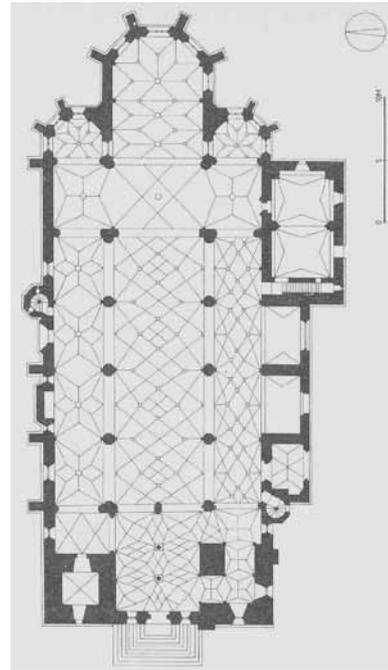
Grundriss der Kirche Maria Saal
